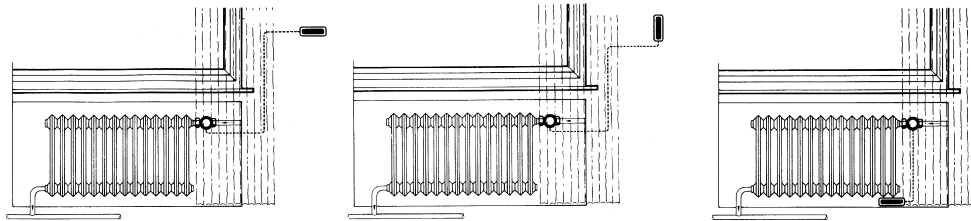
Richtige Einbauposition für Thermostatregler mit Fernfühler
